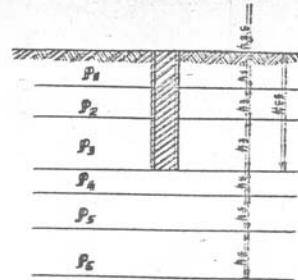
Заземляющие устройства в северных грунтах из угольных вертикальных заземляющих диаметром 2,5м, размещенные в котлованах с песчаным грунтом
